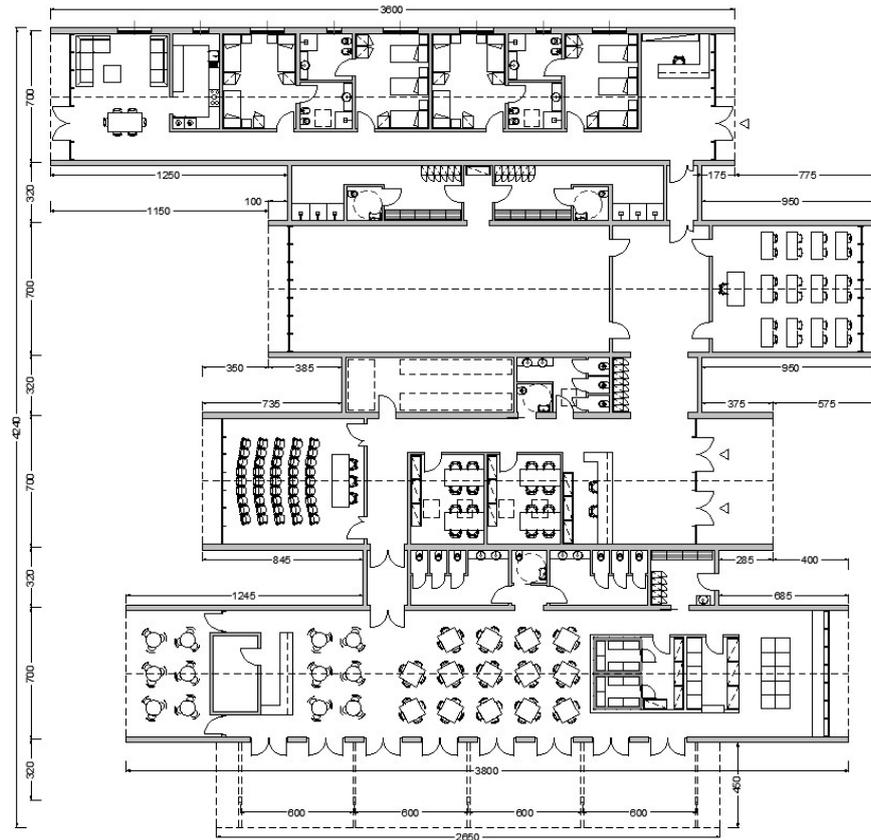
Planimetria particolareggiata edificio principale arredata
